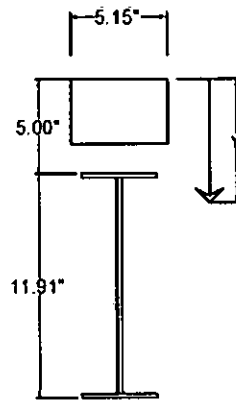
Esquema para el cálculo del centroide de la sección compuesta
